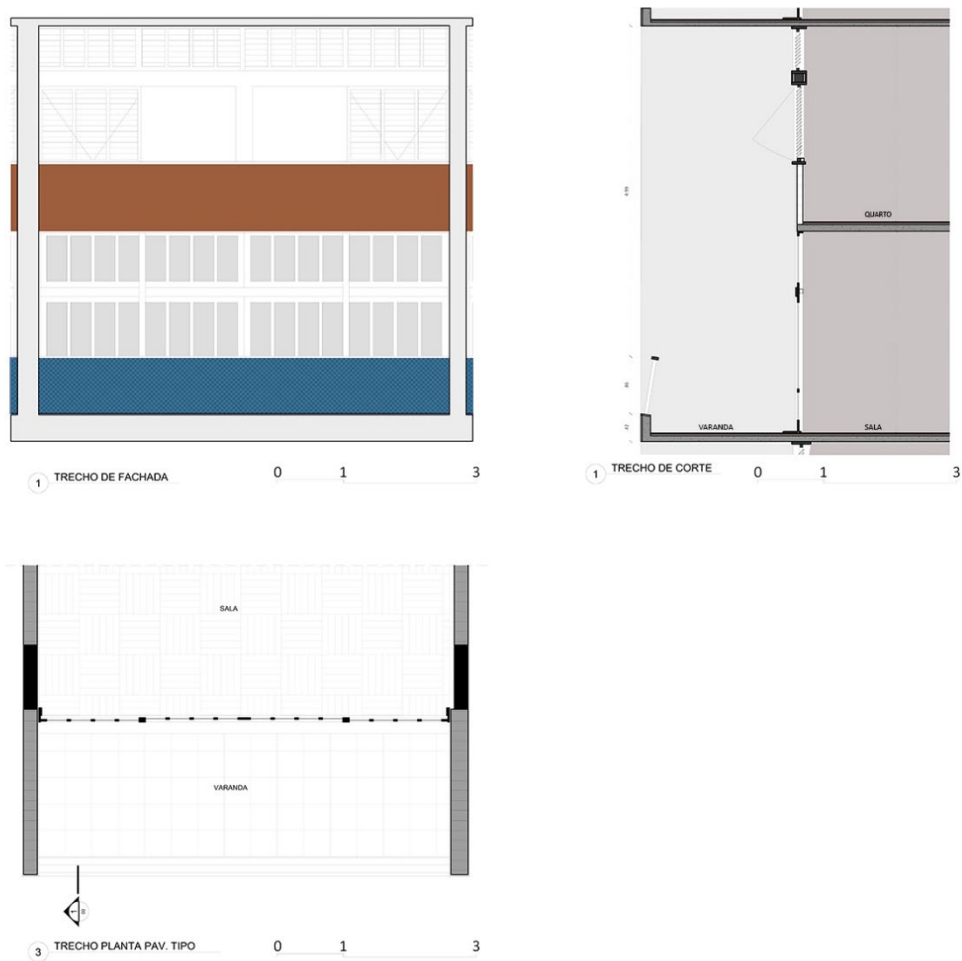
Edifício Júlio Barros Barreto, trecho de planta, trecho de corte e trecho de fachada de um apartamento. Desenhos de Jônatas Sousa da Costa, 2021.
